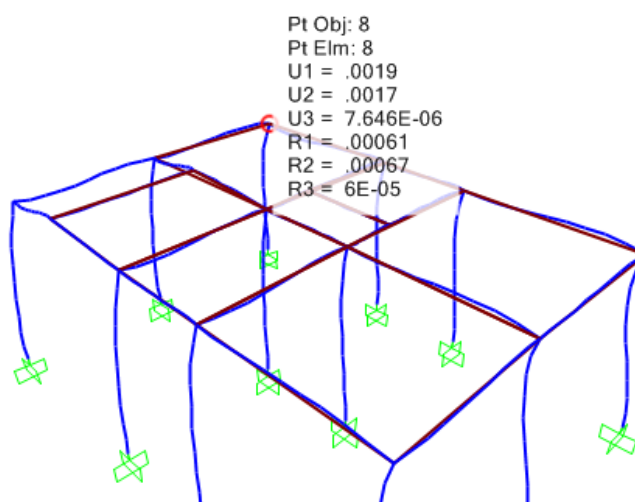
Replanteo en sistema tipo pórtico de viviendas de un piso
